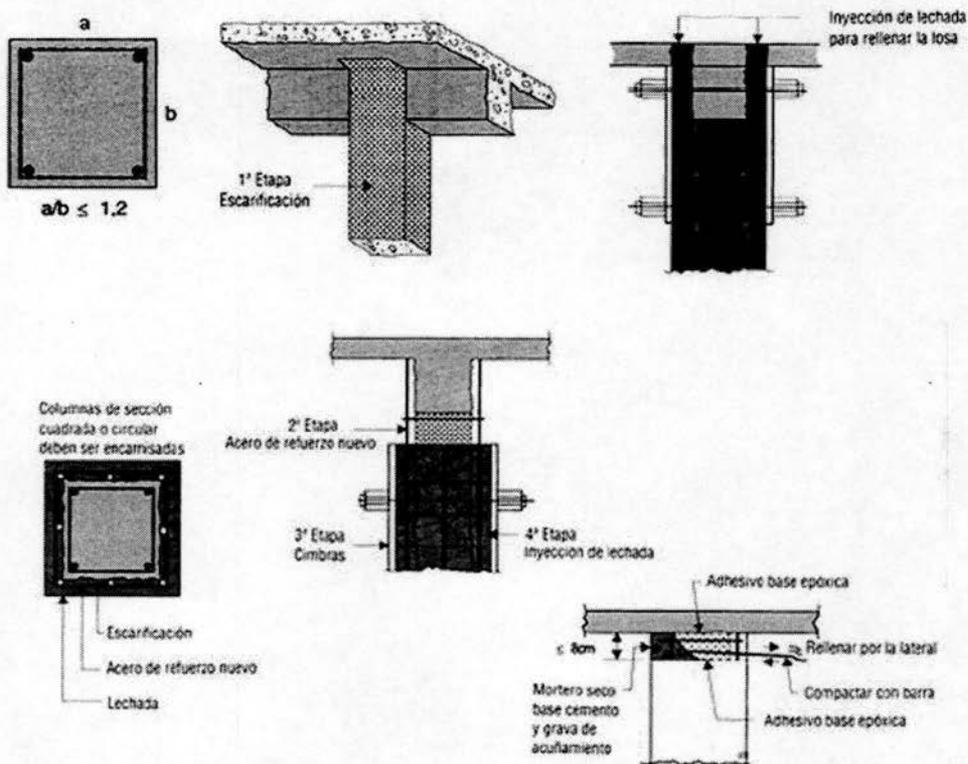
Columnas – Refuerzos con a) Lechada de base cemento / microconcreto fluido, b) Lechada de base epoxica y c) concreto
